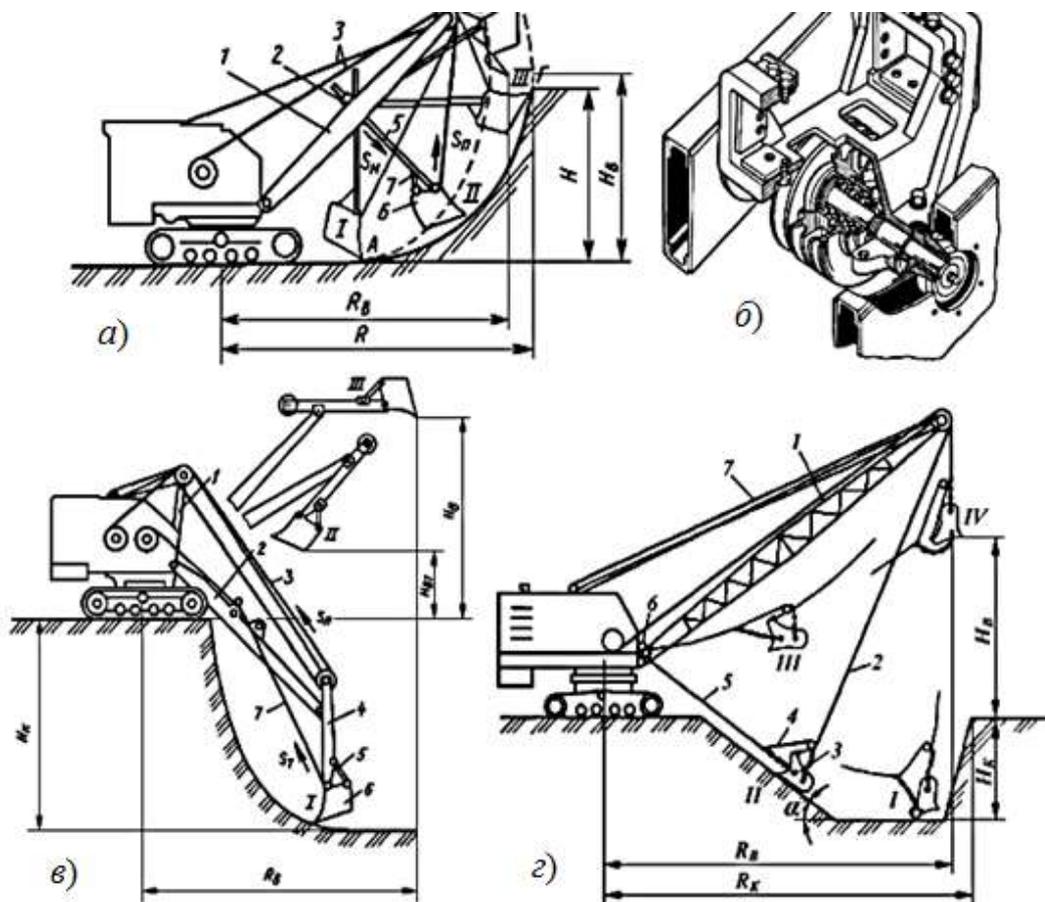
Экскаваторы с гибкой подвеской рабочего оборудования: *а* – прямая лопата; *б* – седловой подшипник прямой лопаты; *в* – обратная лопата; *г* – драглайн.
